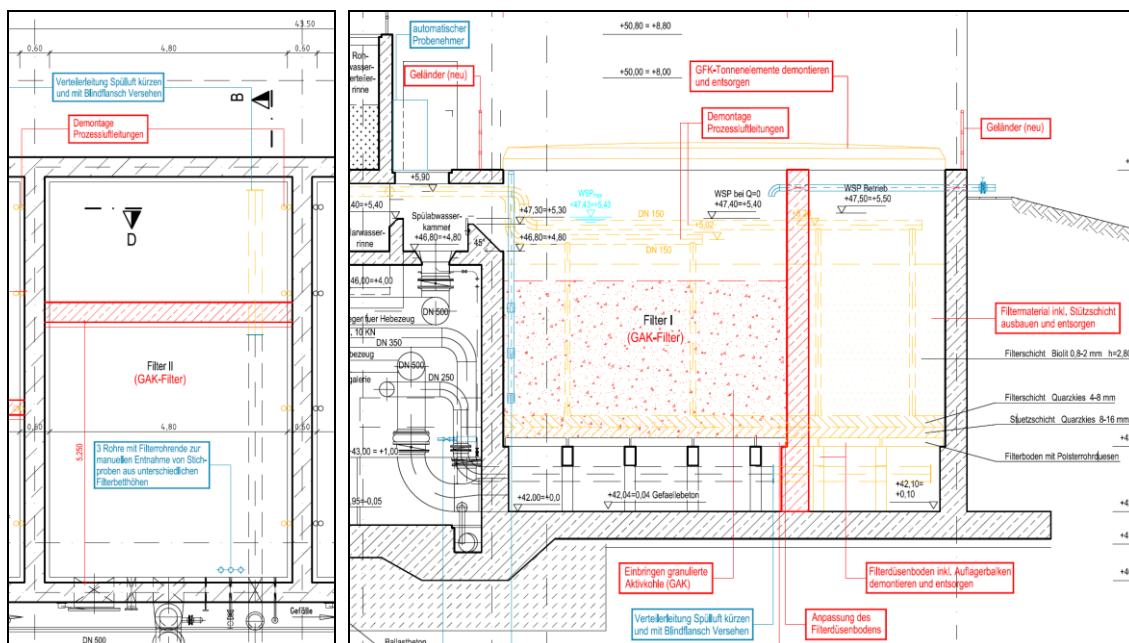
Grundriss (links) und Längsschnitt (rechts) des GAK-Filters
